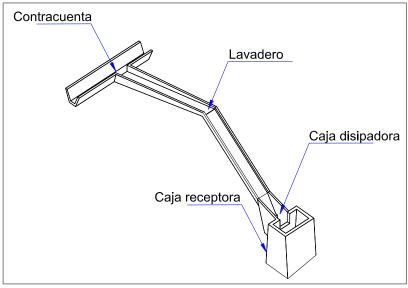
Disposición de lavadero entre contracuneta y cuneta en drenaje superficial, Sección en corte, Detalle, 2017
